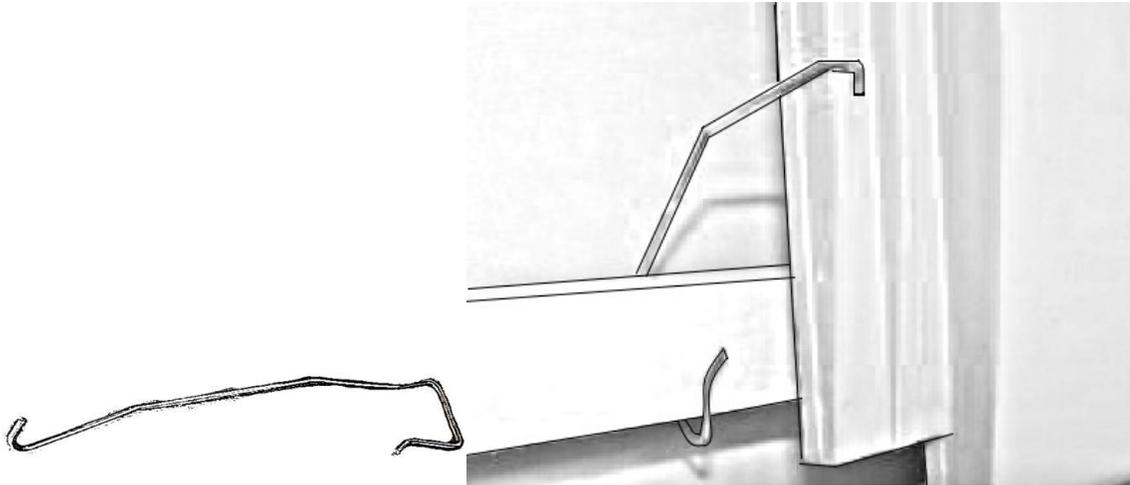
croquis d'un crochet et sa mise en œuvre sur tuile à emboîtement
